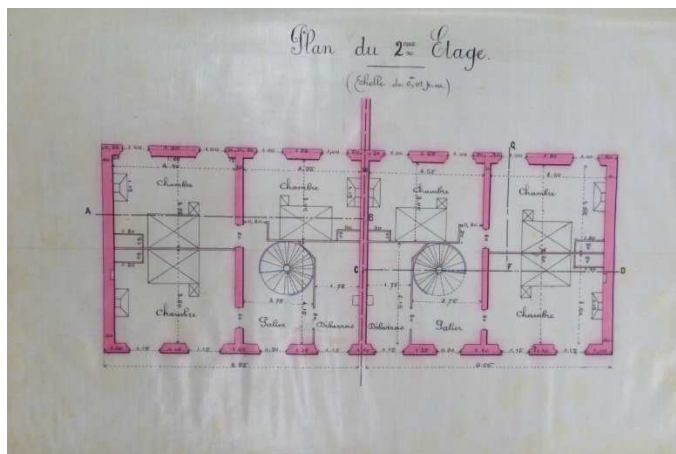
Plan d'ensemble, Maurel Marie (architecte).
